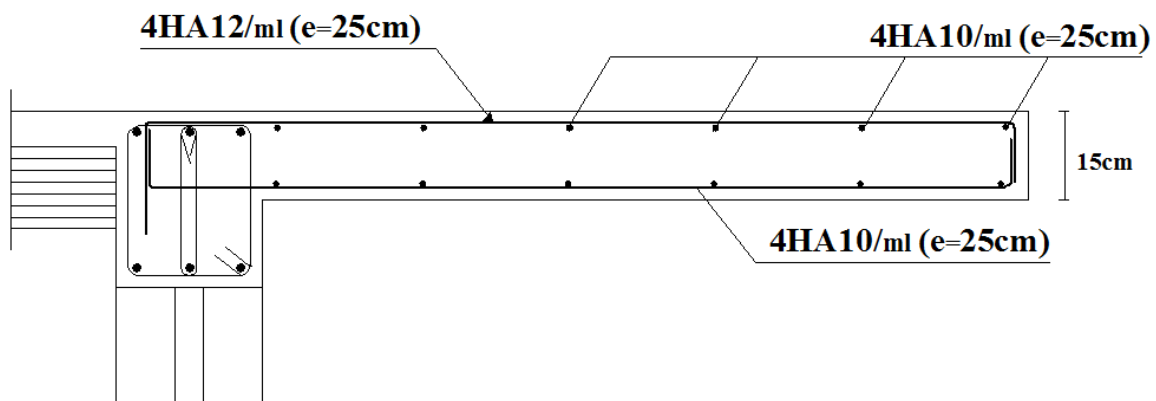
A) : Ferrailage de la dalle pleine de type console
